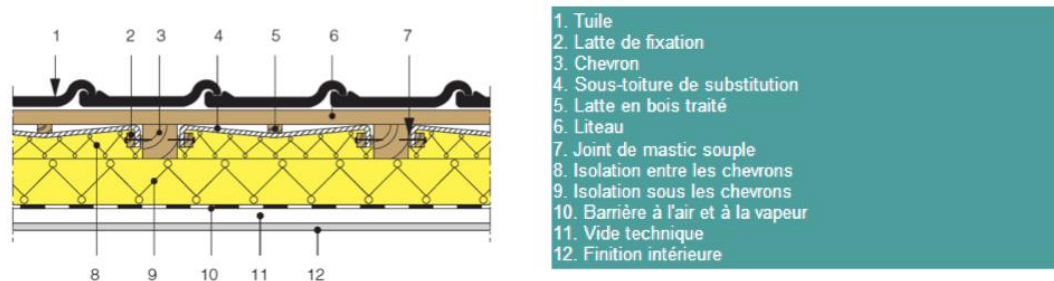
Coupe transversale d'une toiture existante sans contre-lattes, munie a posteriori d'une isolation et d'une sous-toiture de substitution (Dobbels, 2009)
